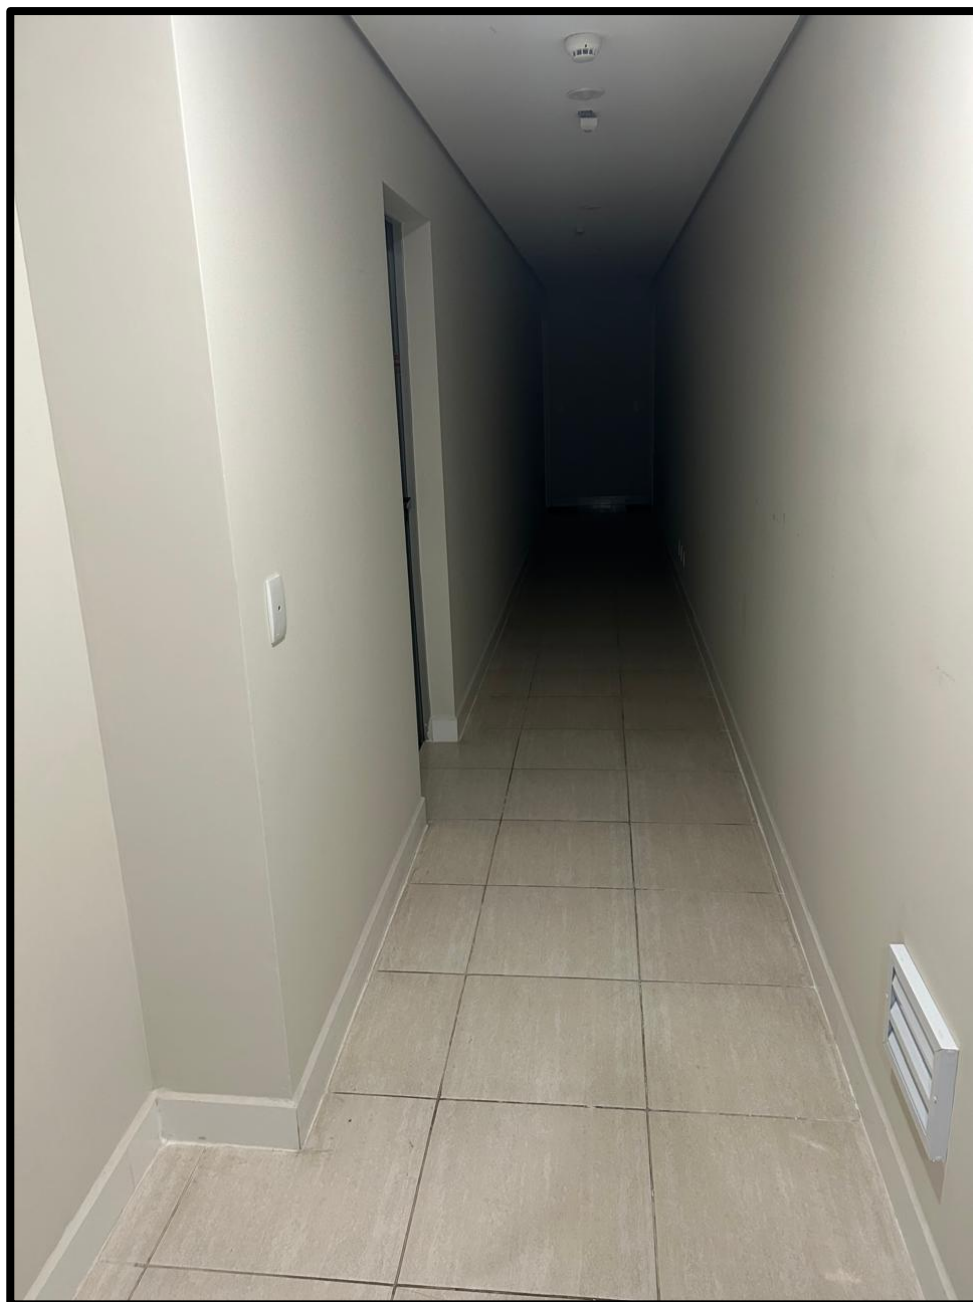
Vista do hall de entrada da unidade em tela.
